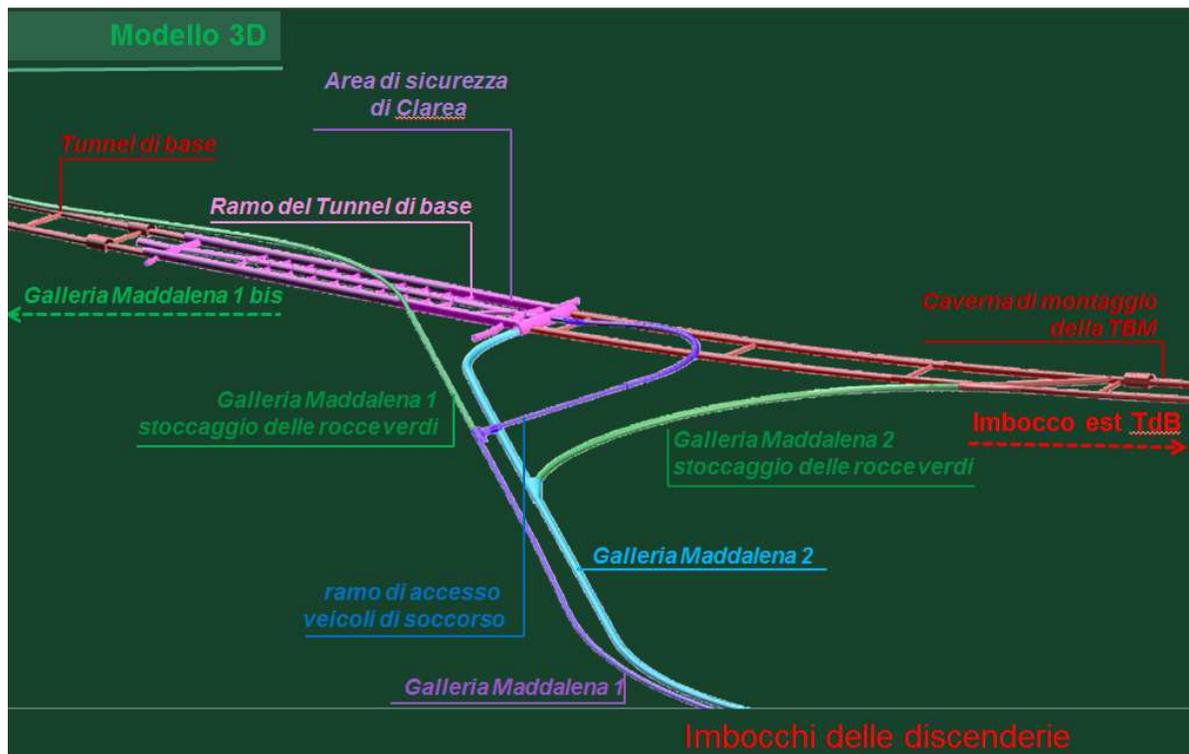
Modello 3D Tunnel di Base e siti di deposito sotterraneo pietre verdi
